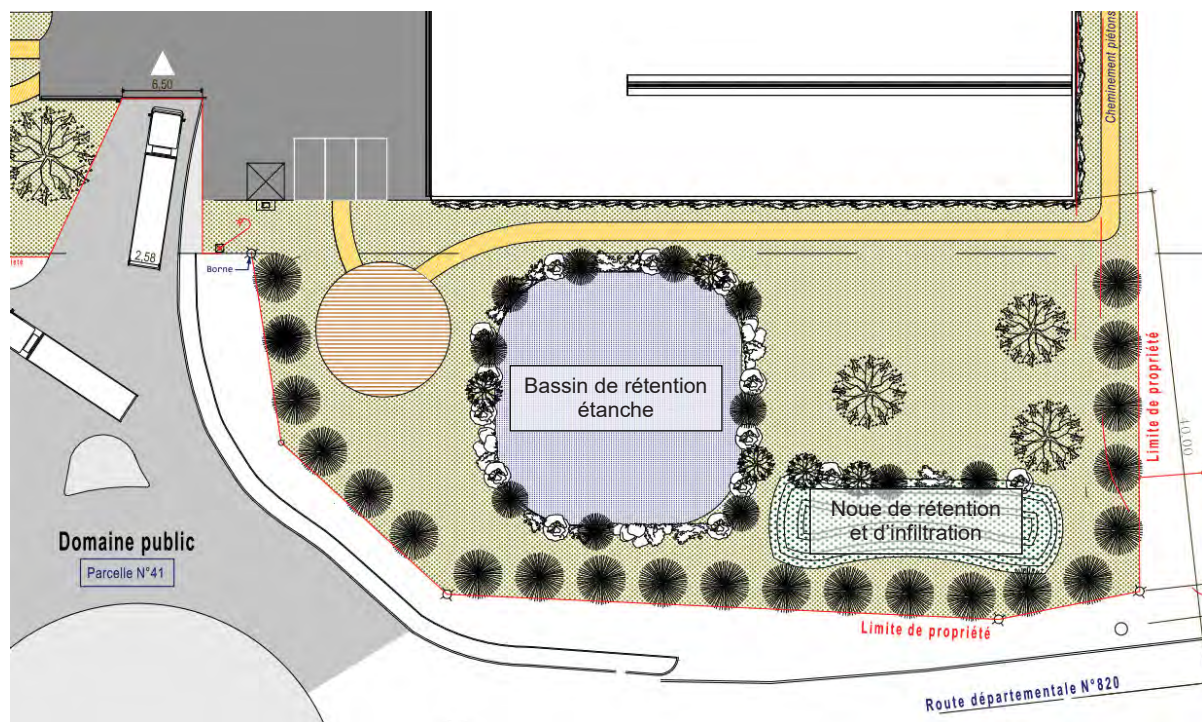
Plan des ouvrages de gestion des eaux de ruissellement en zone 2
